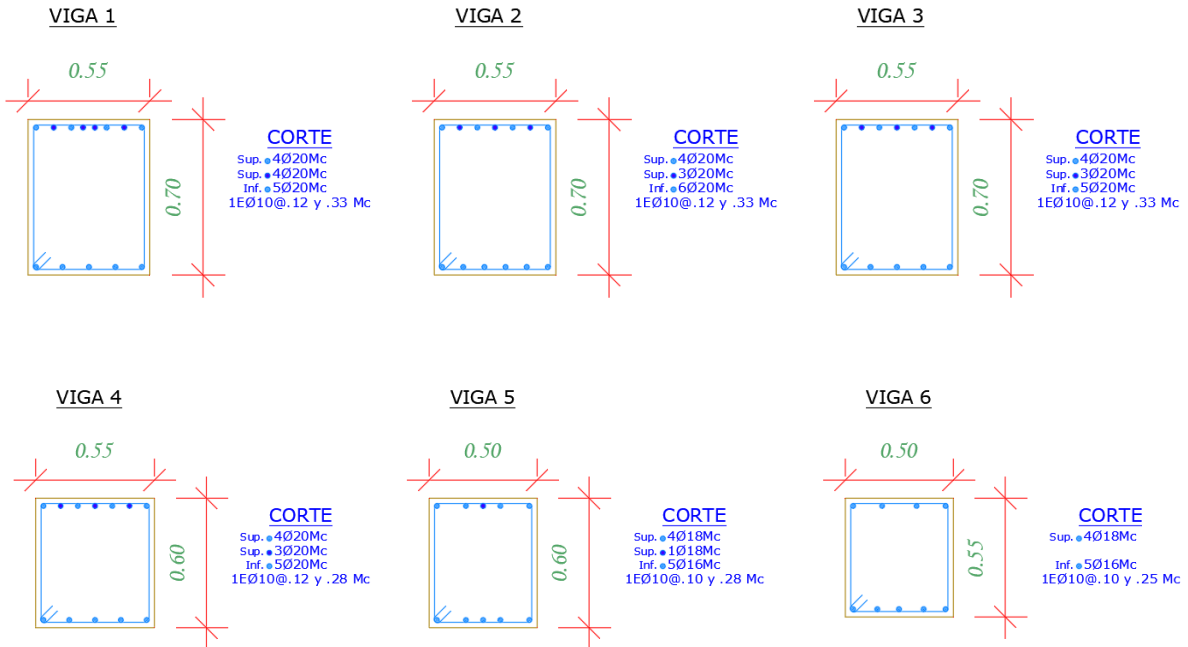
Secciones transversales de las vigas utilizadas en un edificio de 9 pisos
